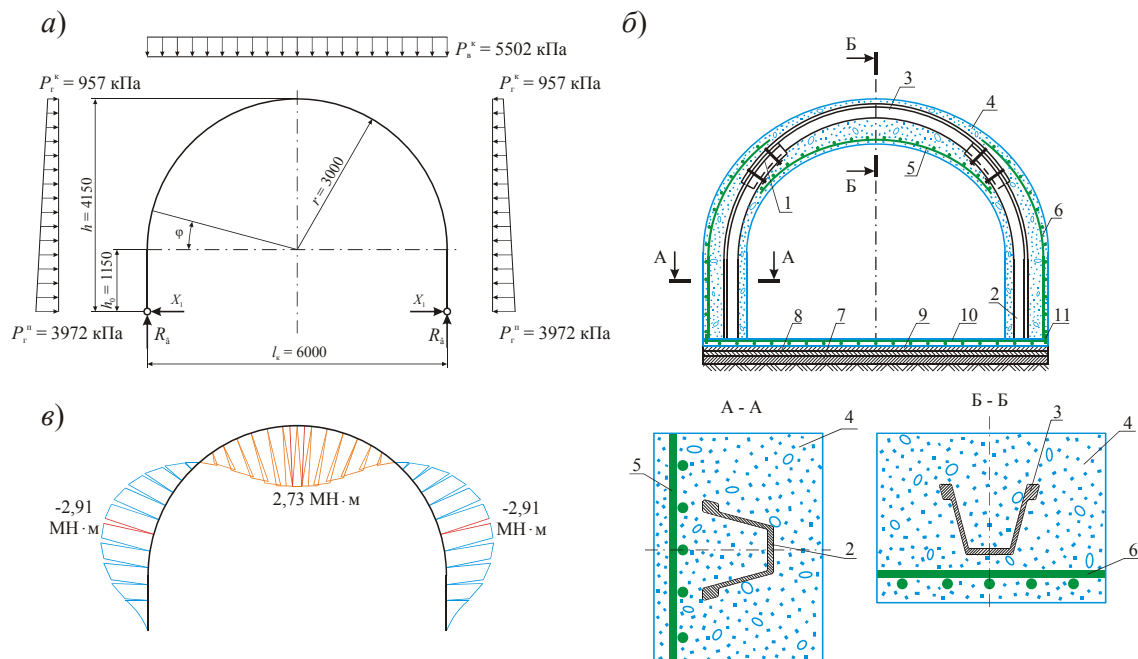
Металлическая арочная крепь с монолитным бетоном:
